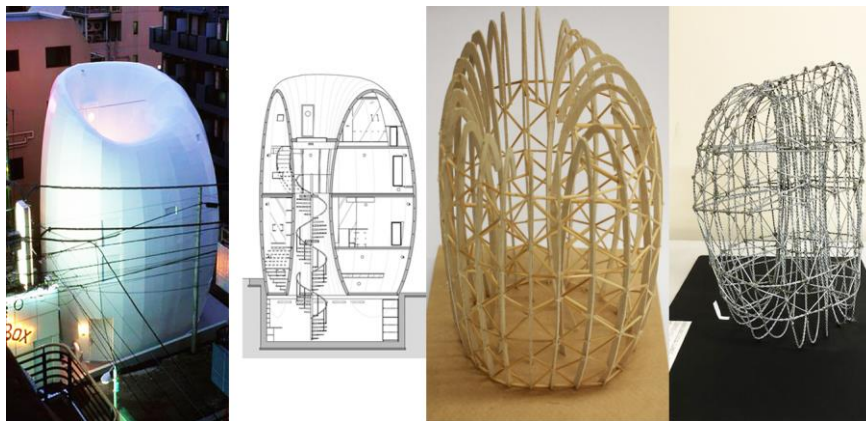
Imagem Casa Elipse – Tóquio. Japão, projeto CAD e maquetes com estruturação em madeira e arame.
